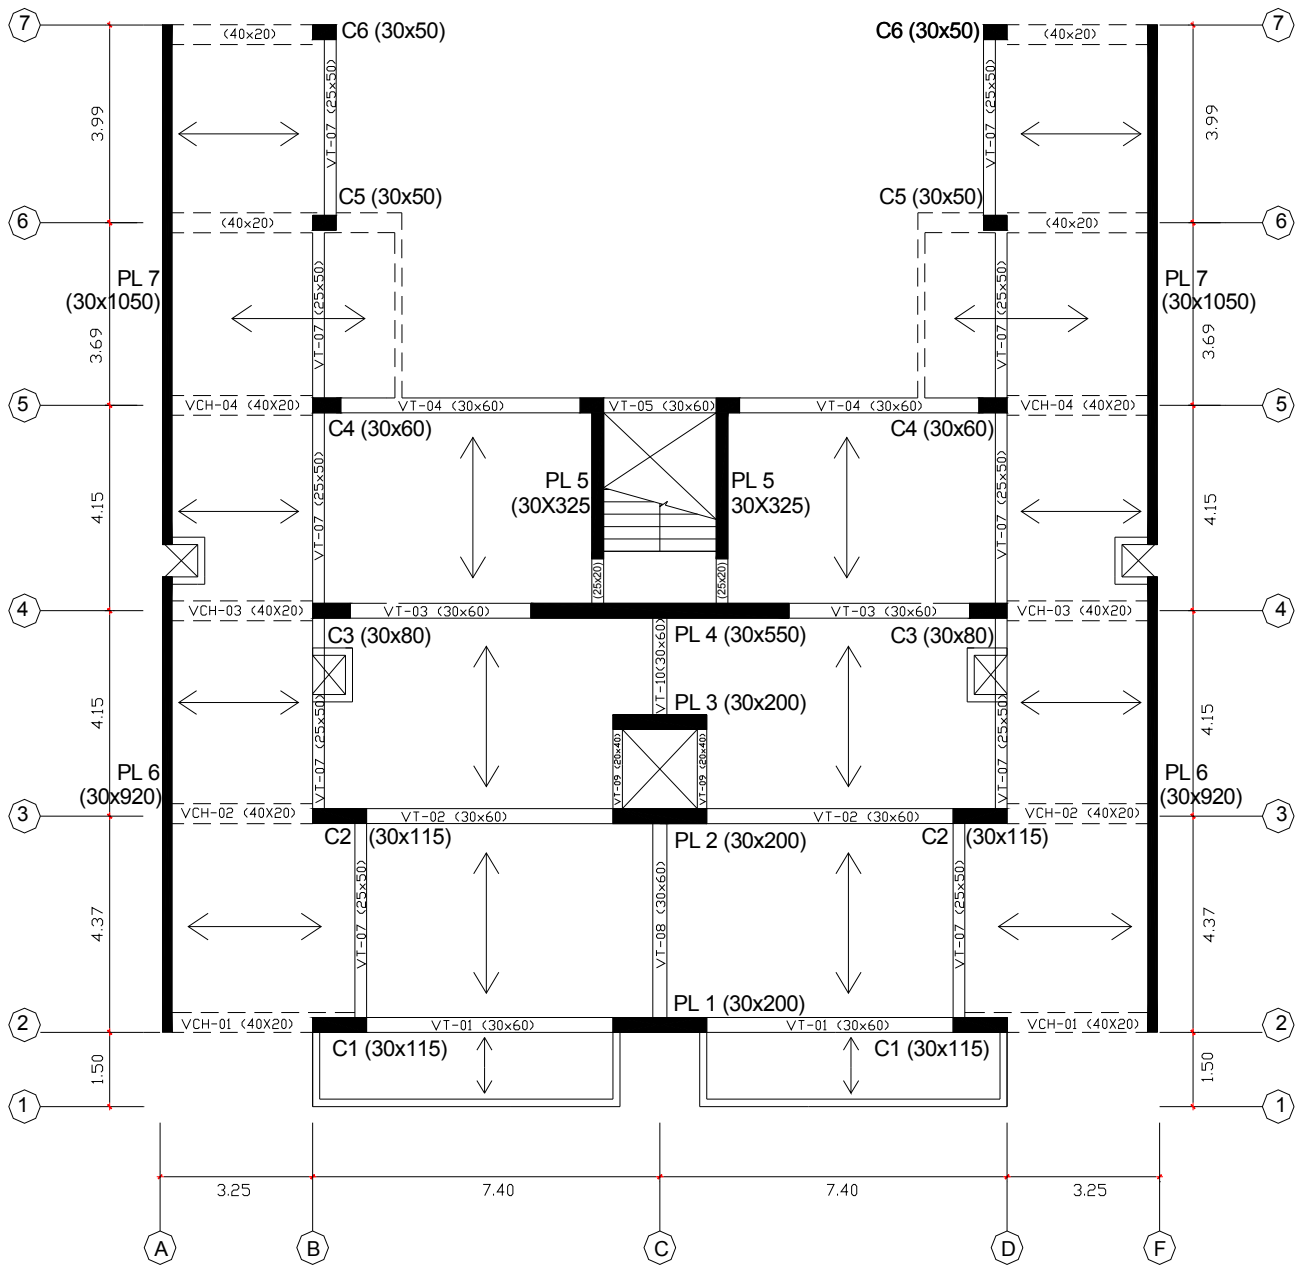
Predimensionamiento de Elementos Estructurales de la Planta Típica
